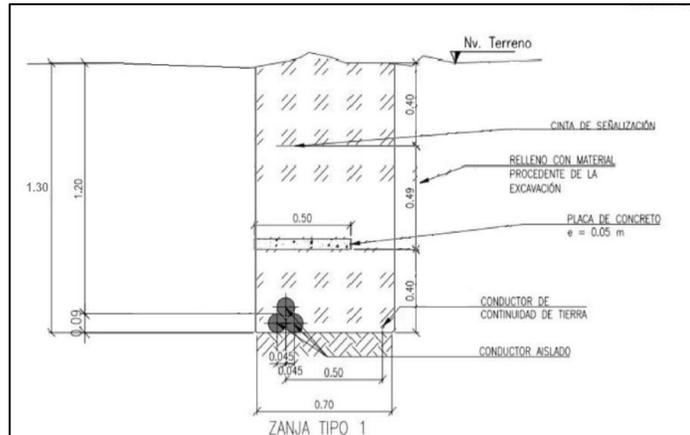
Sección transversal excavación para tramo subterráneo (sobre zona de playa y Carrera 14A)
